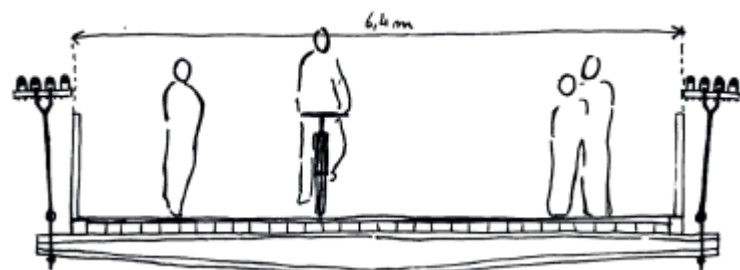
Choix du traitement du profil en travers, croquis RL&A
